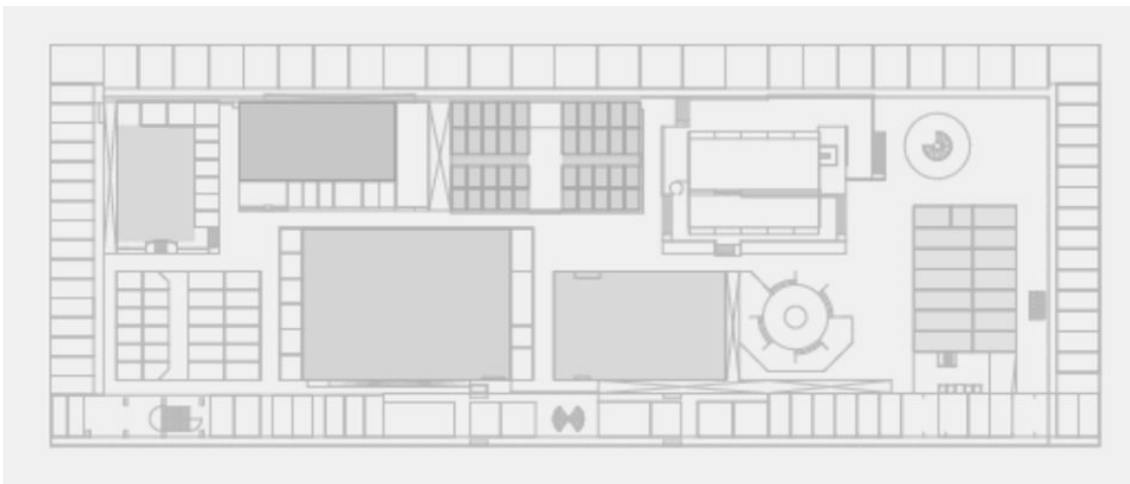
Planta baixa térrea do Conic. Fonte: REZENDE, 2014.
